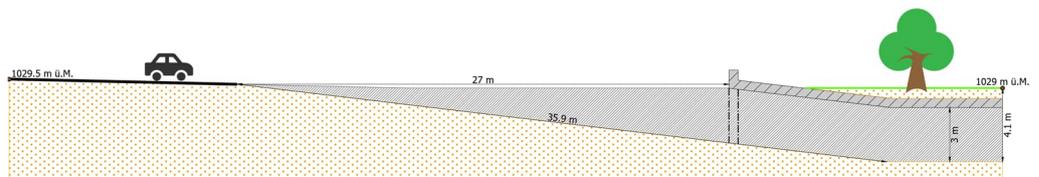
Schnitt Einfahrt Tiefgarage Variante 2c (massstabslos)
